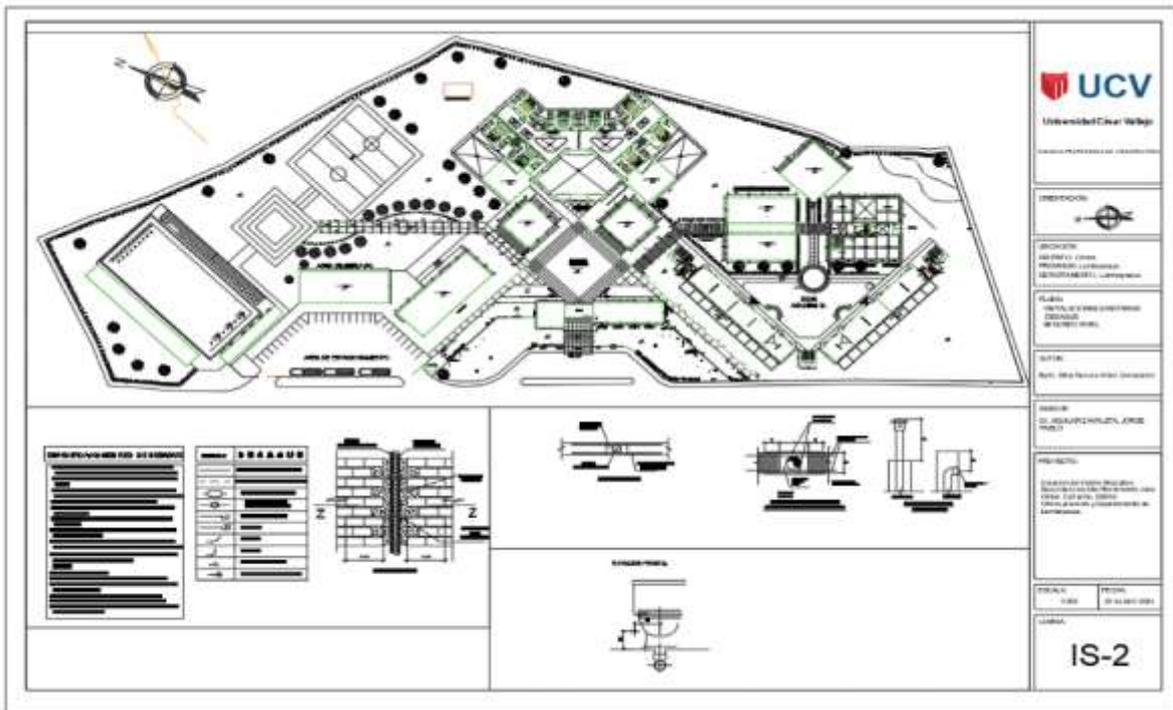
SEGUNDA PLANTA -DESAGUE
